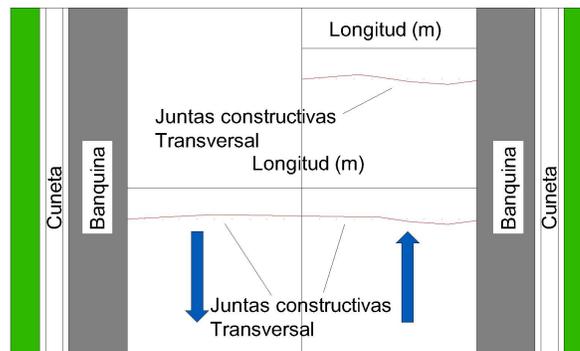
Fisura transversal en junta de construcción (FCT, Unidad de medida: m²-carril)
